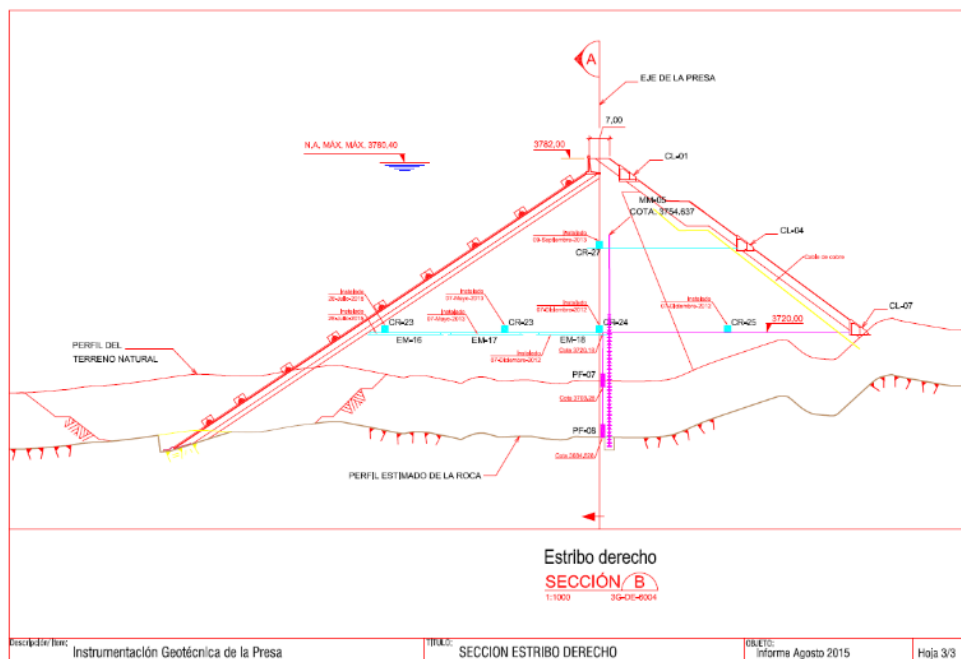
Sección estribo derecho de la presa con el detalle de los instrumentos instalados.
